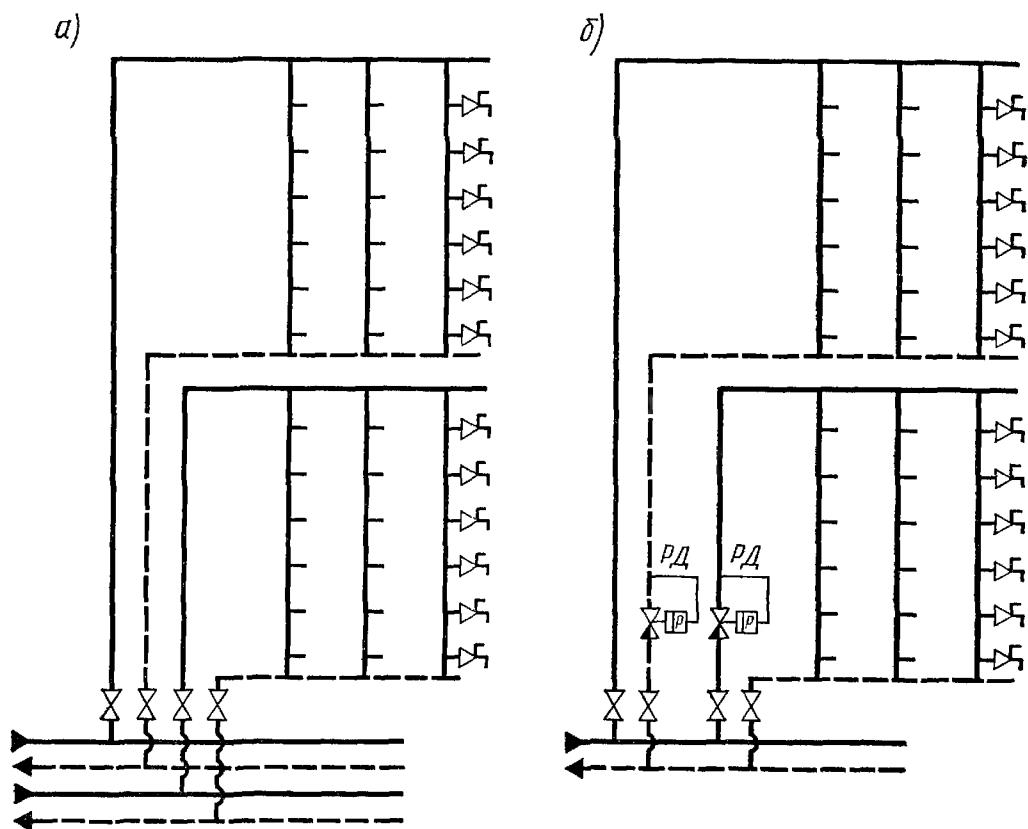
Схема горячего водоснабжения зданий повышенной этажности
